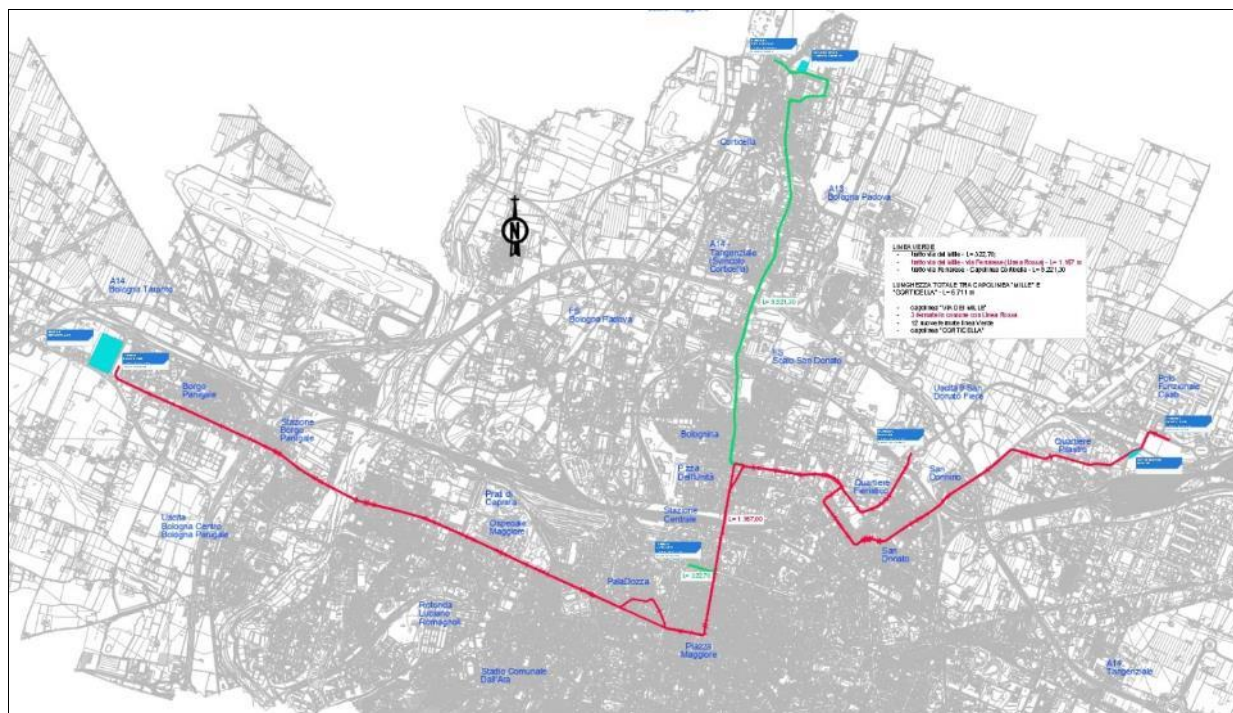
Planimetria generale Linea rossa + Tratta nord Linea Verde
